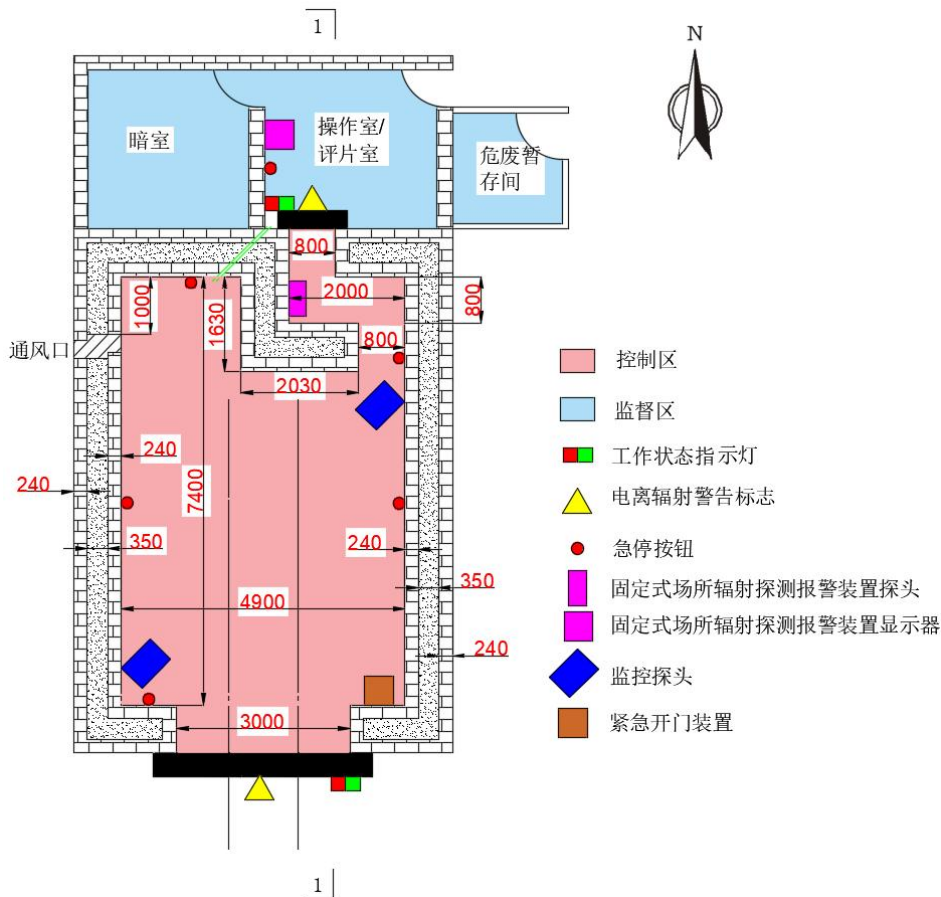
(a) 拟建探伤场所平面布置示意图（单位：mm）
